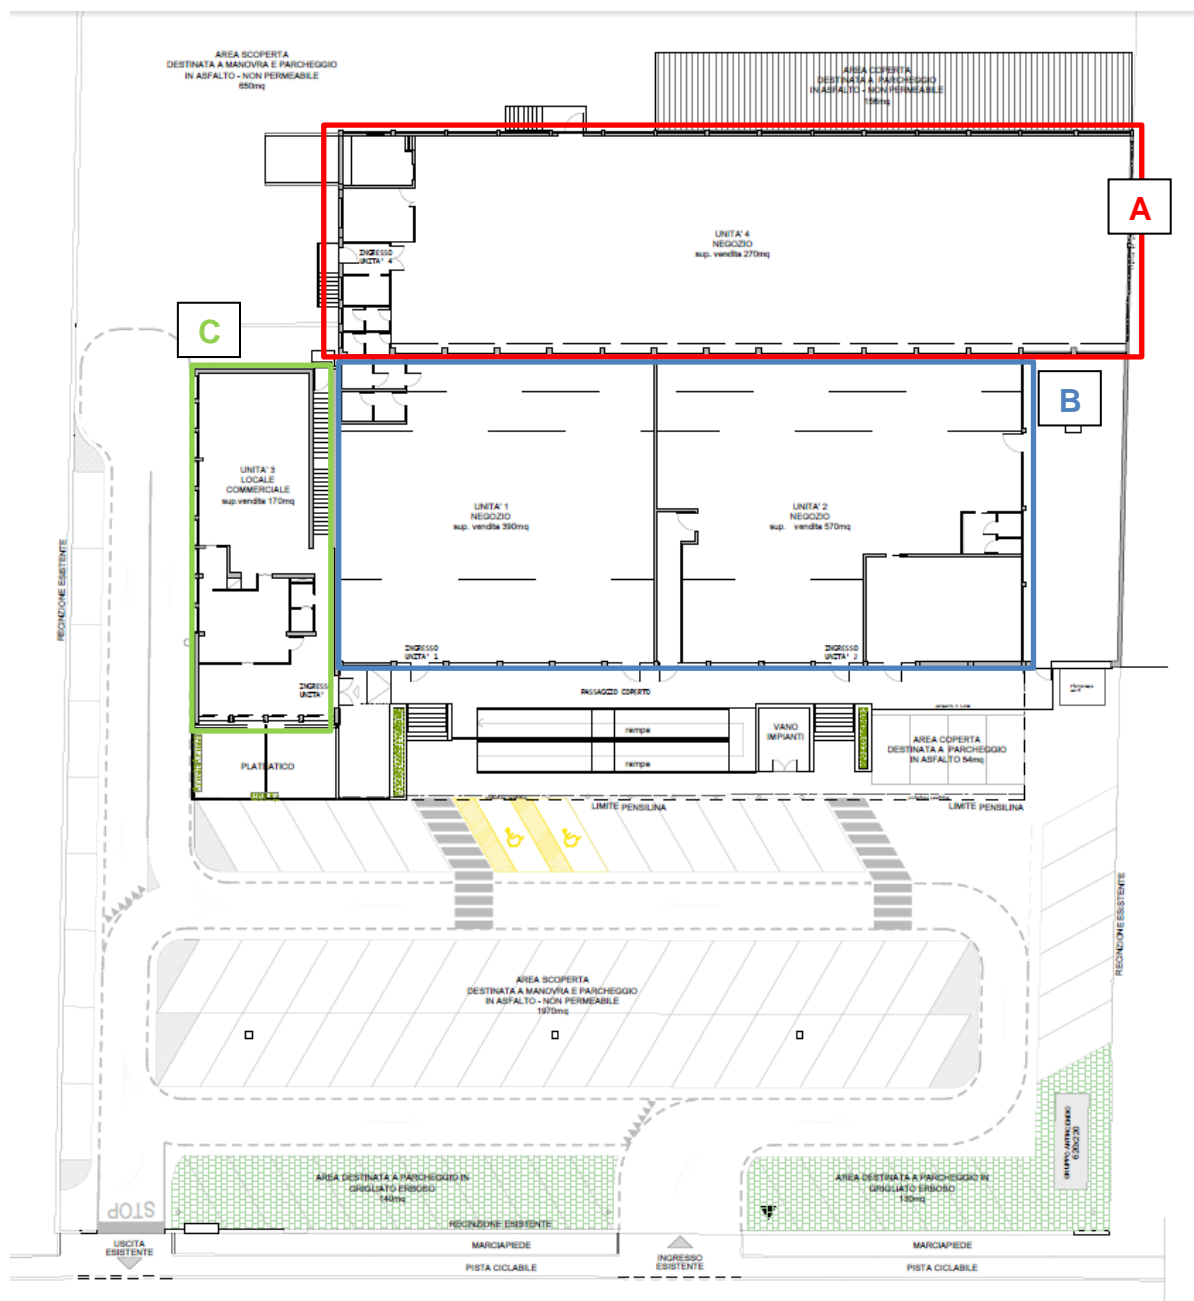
Stralcio elaborato PE-Planimetria di progetto
